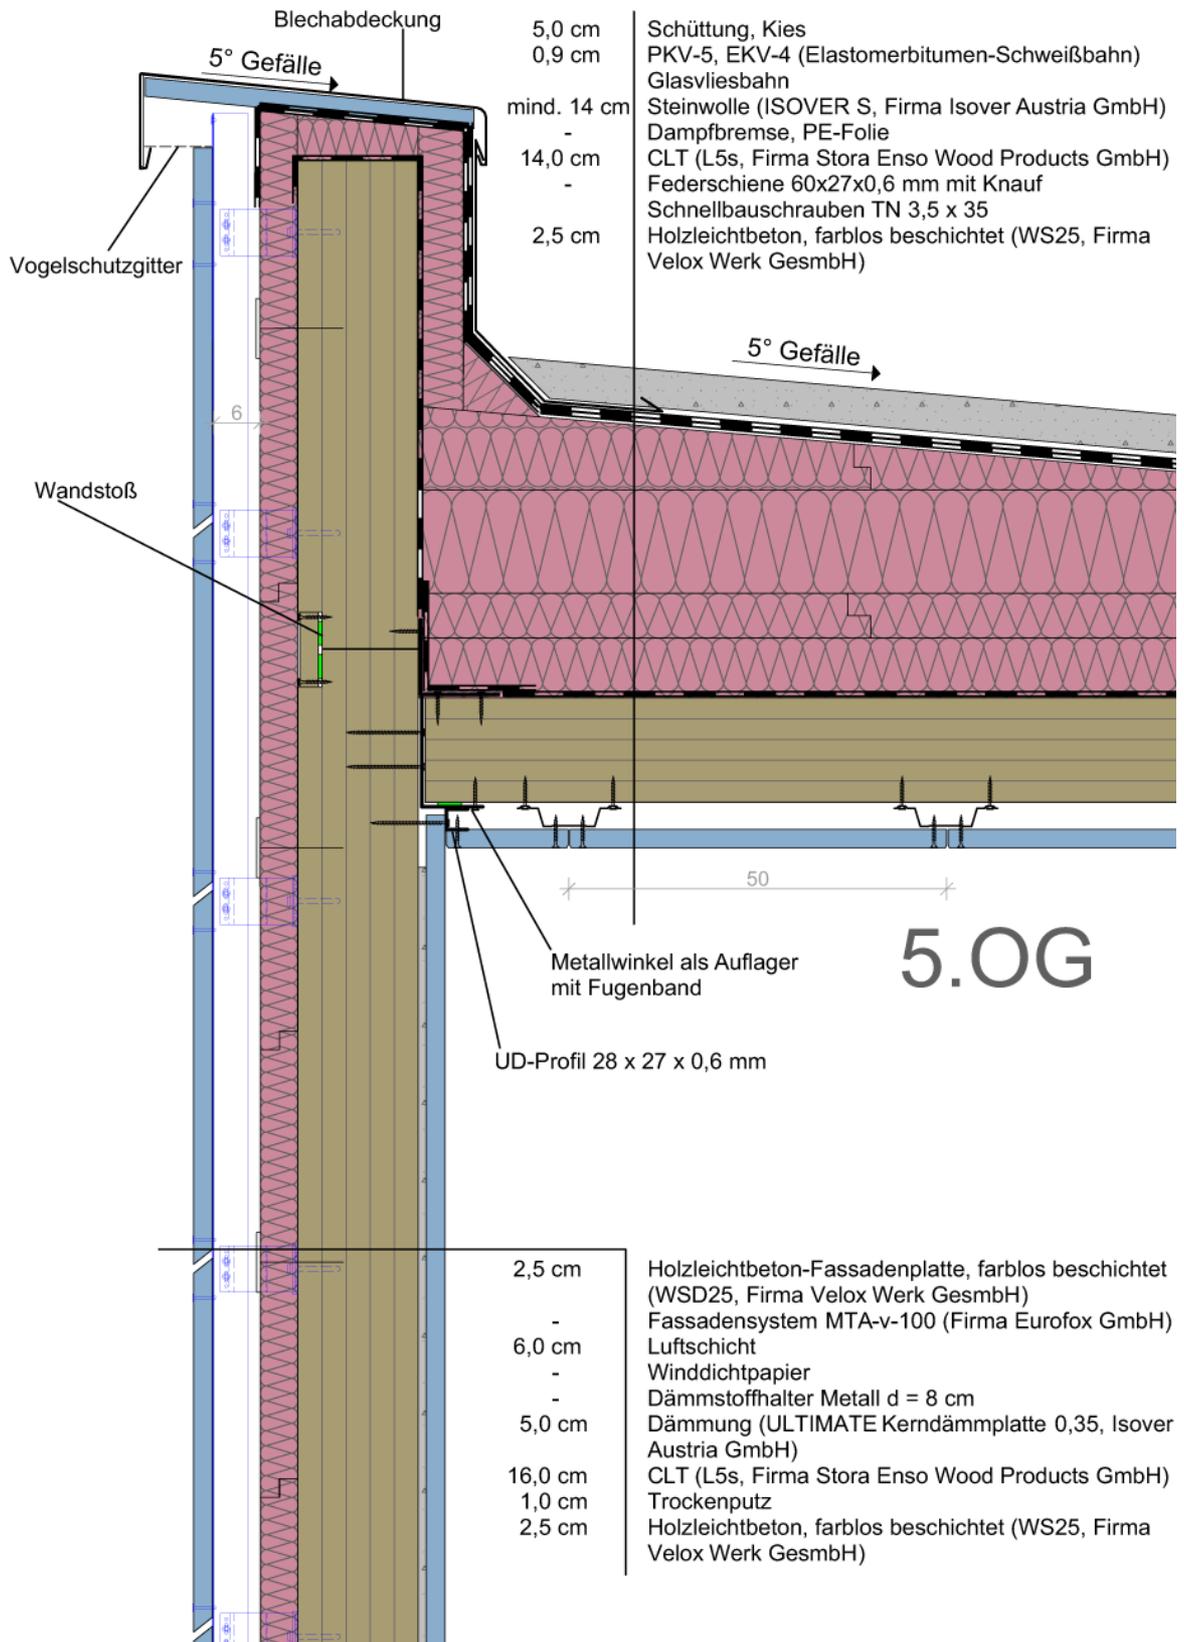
Detail 1:10 - Anschluss Außenwand-Dach
